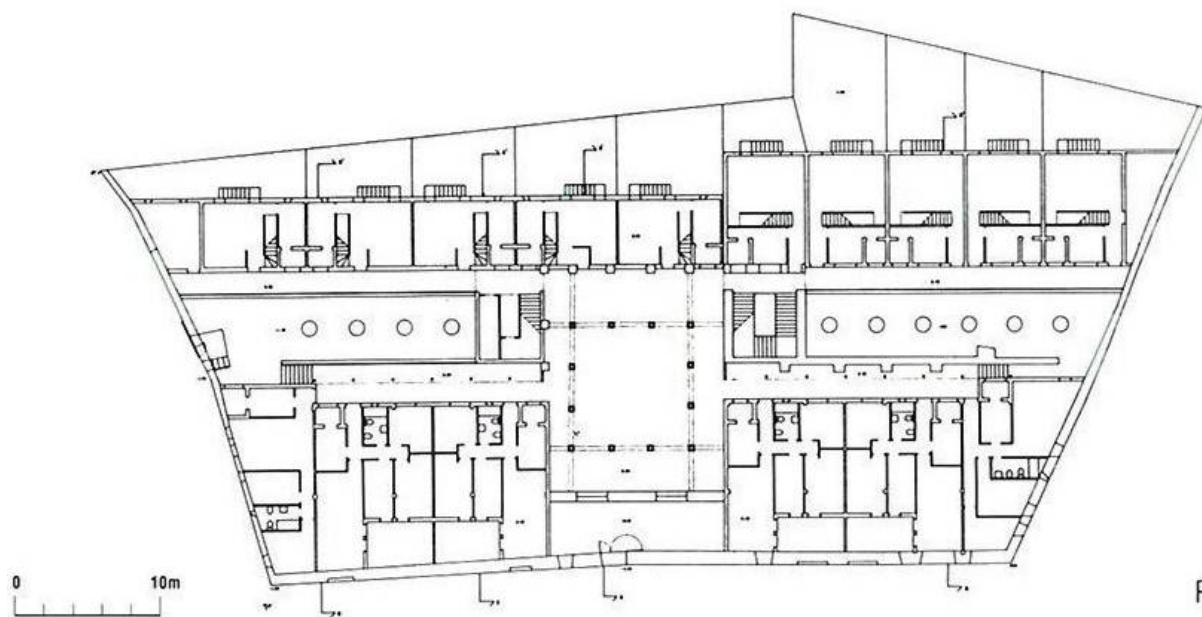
Planta baja. Proyecto de rehabilitación del antiguo convento de Santa Catalina para viviendas sociales. (Junta de Andalucía. b, 1997).
